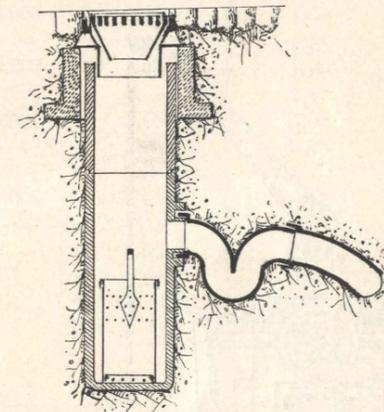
Pozzetto a sabbia tipo di Varsavia per strade piane (Sezione verticale).
